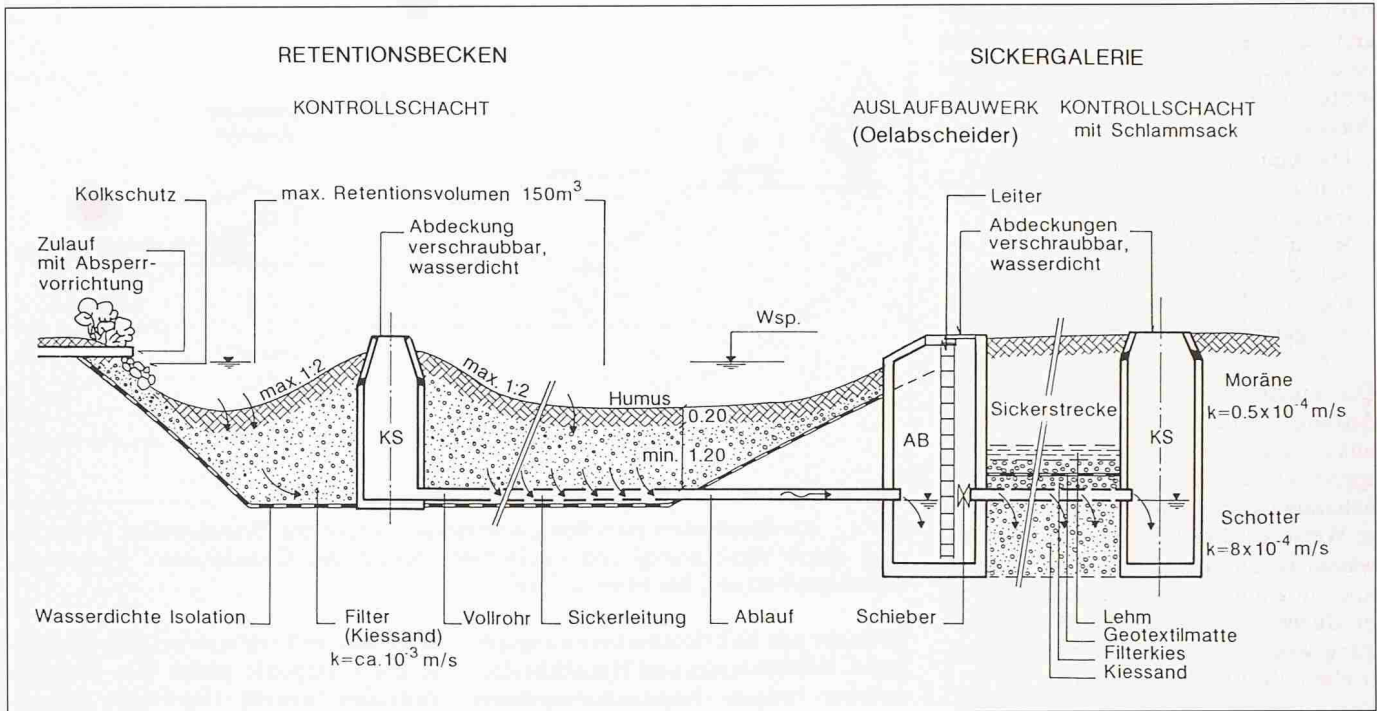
Schema einer Versickerungsanlage für Dachwasser in Industriegebieten (abgeändert nach AGW, Zürich). Länge der Sickergalerie: 40 m
